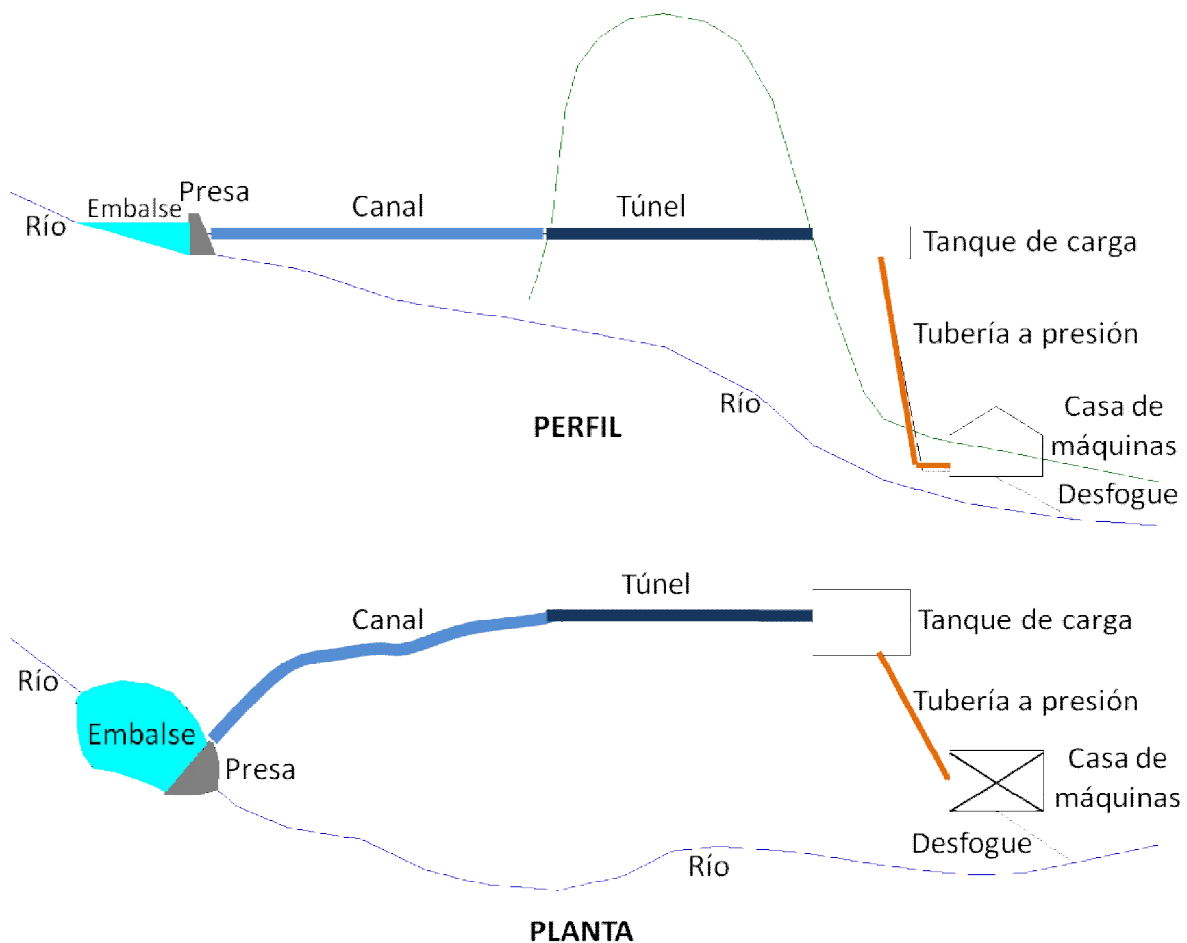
Planta y perfil de una pequeña central de alta carga
